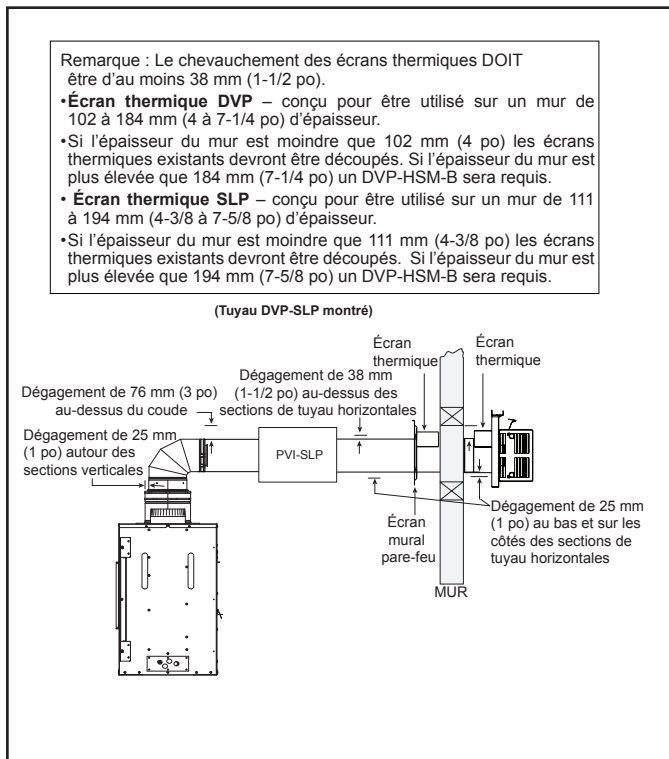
Dégagements du conduit horizontal par rapport aux matériaux inflammables
